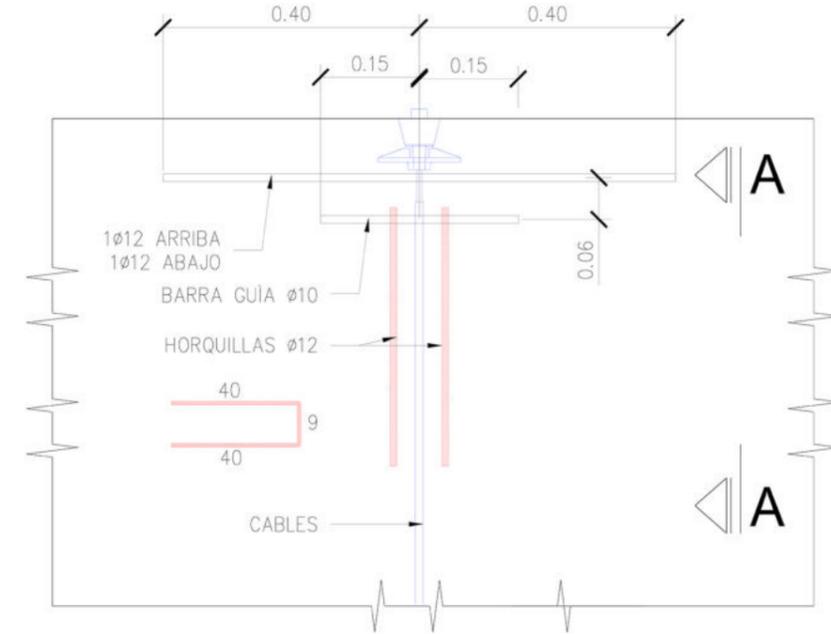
PLATEA DE FUNDACION ARMADURA - CABLES EN LOSA (X)
